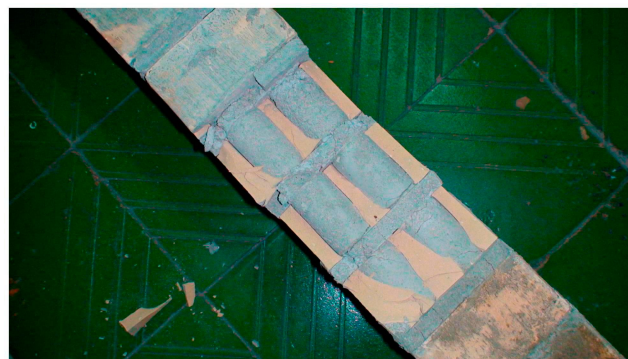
Характер соединения продольной и поперечной арматуры с кирпичом
